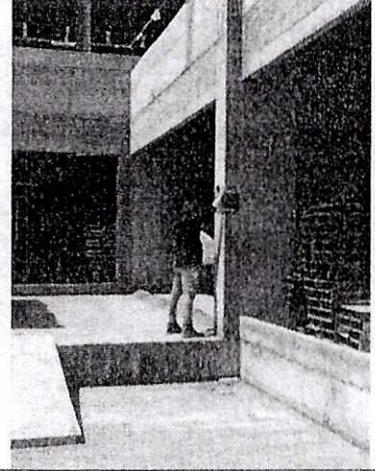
Colocación de sello de suspensión en el acceso frontal de la edificación.
